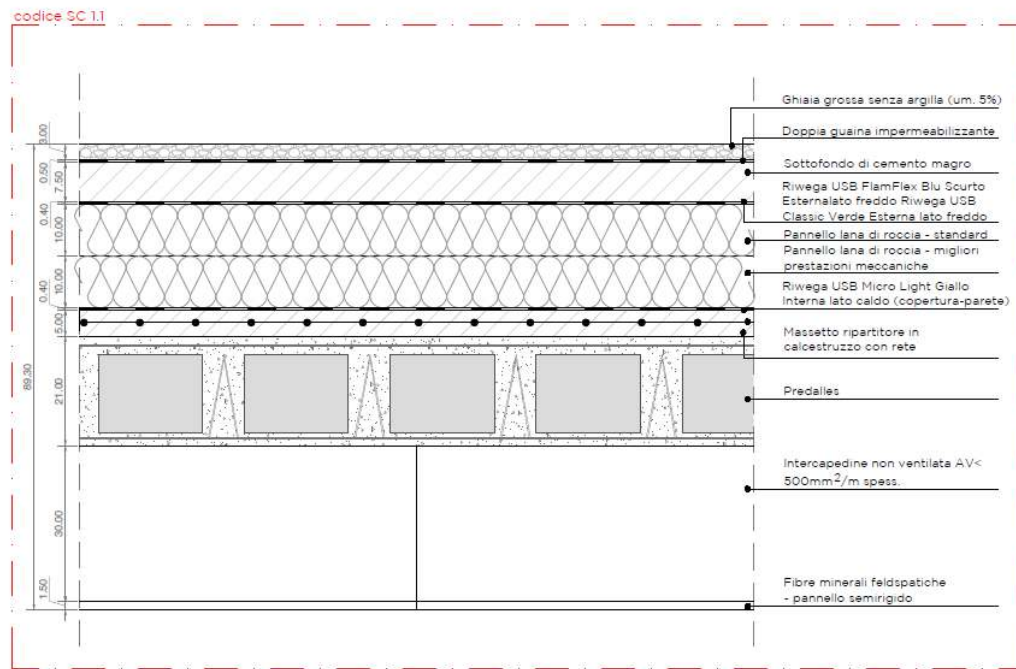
Dettaglio costruttivo copertura. Estratto Tav.04.2_Stato di progetto_Sezione e dettagli
